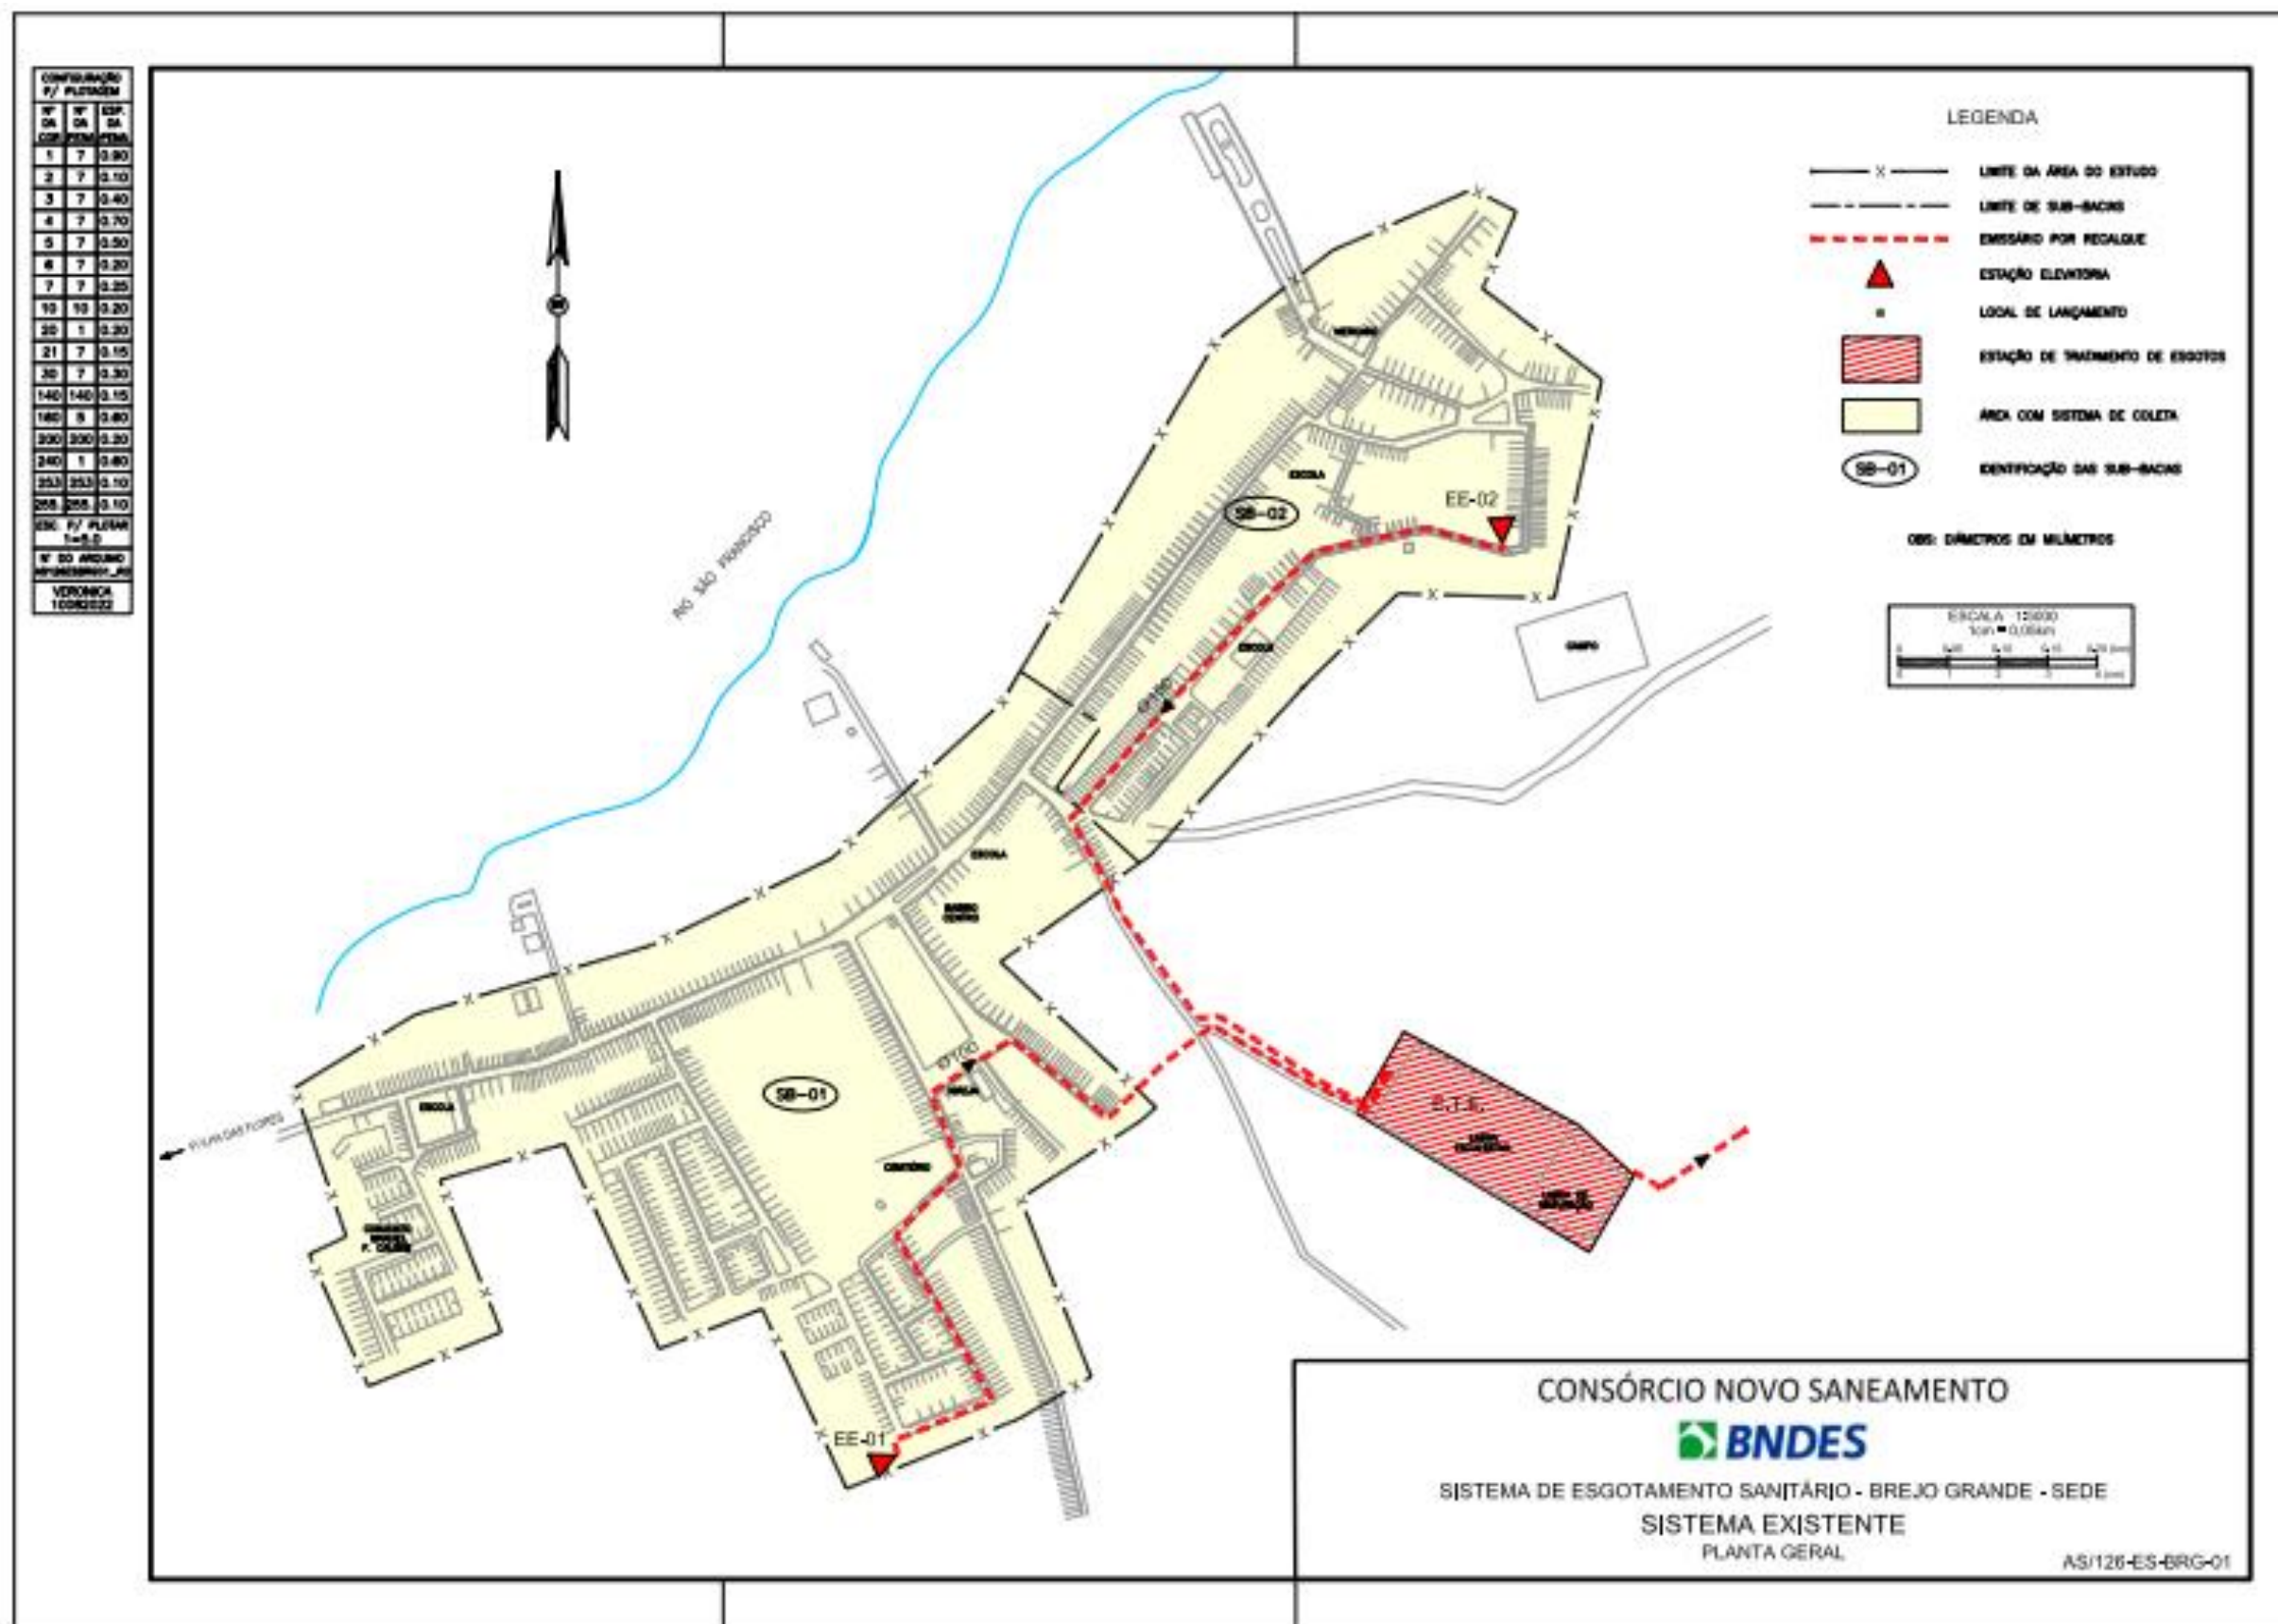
Planta do Sistema de Esgotamento Sanitário – BREJO GRANDE
